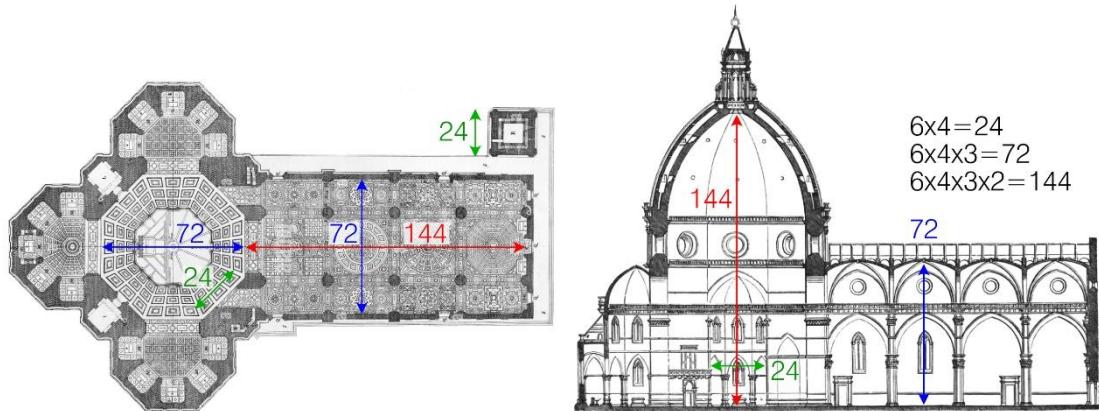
Plan et coupe de Brunelleschi, de Santa Maria del Fiore, annoté avec dimensions clefs
